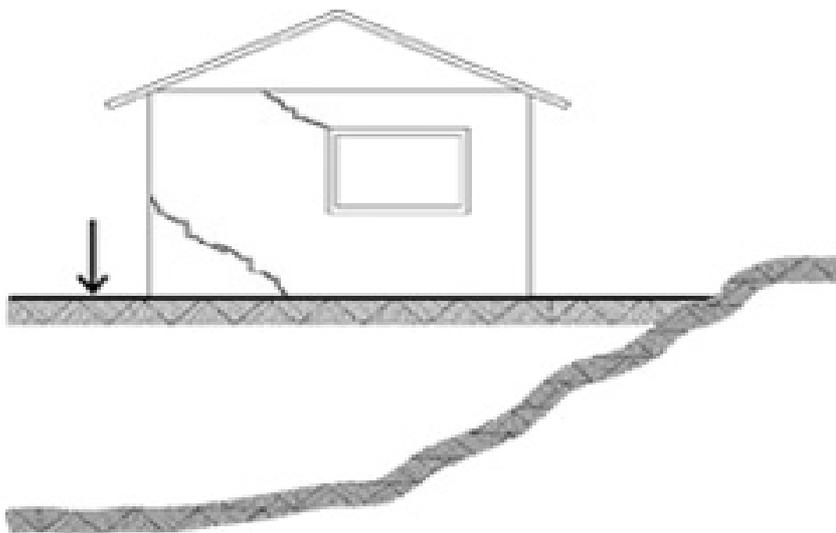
Fissuras causadas por movimentação da fundação (THOMAZ, 1989).
